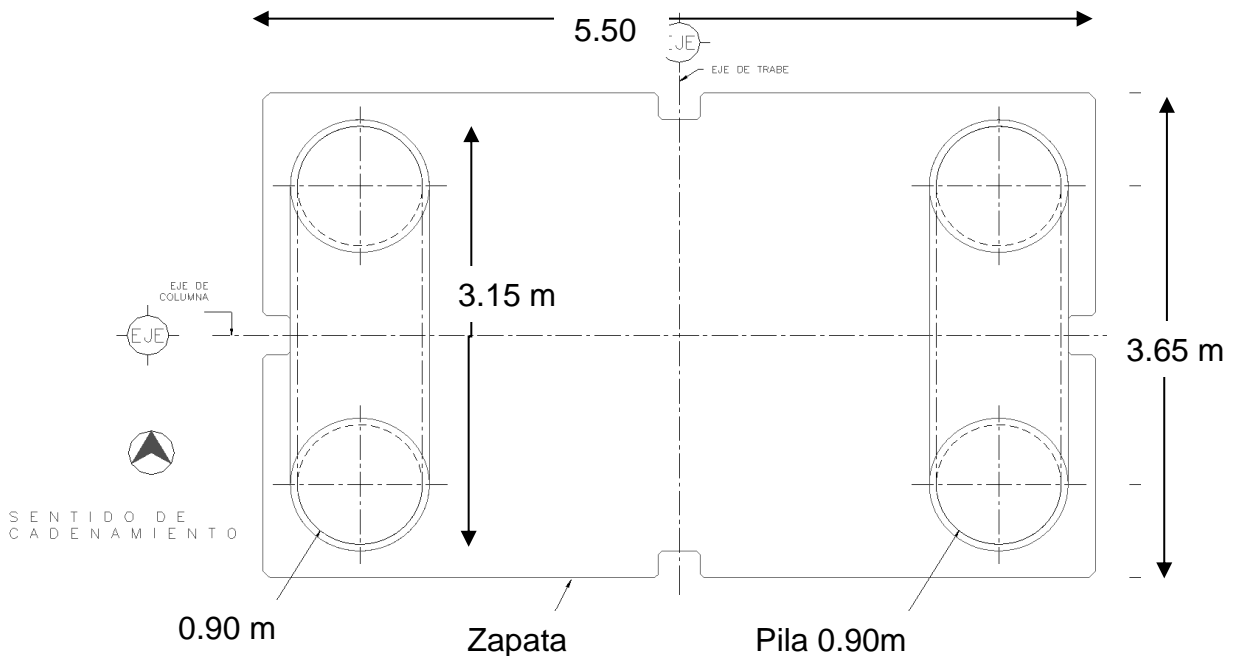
Proyecto geométrico -Pilas Oblongas - Zona II o Zona de Transición
